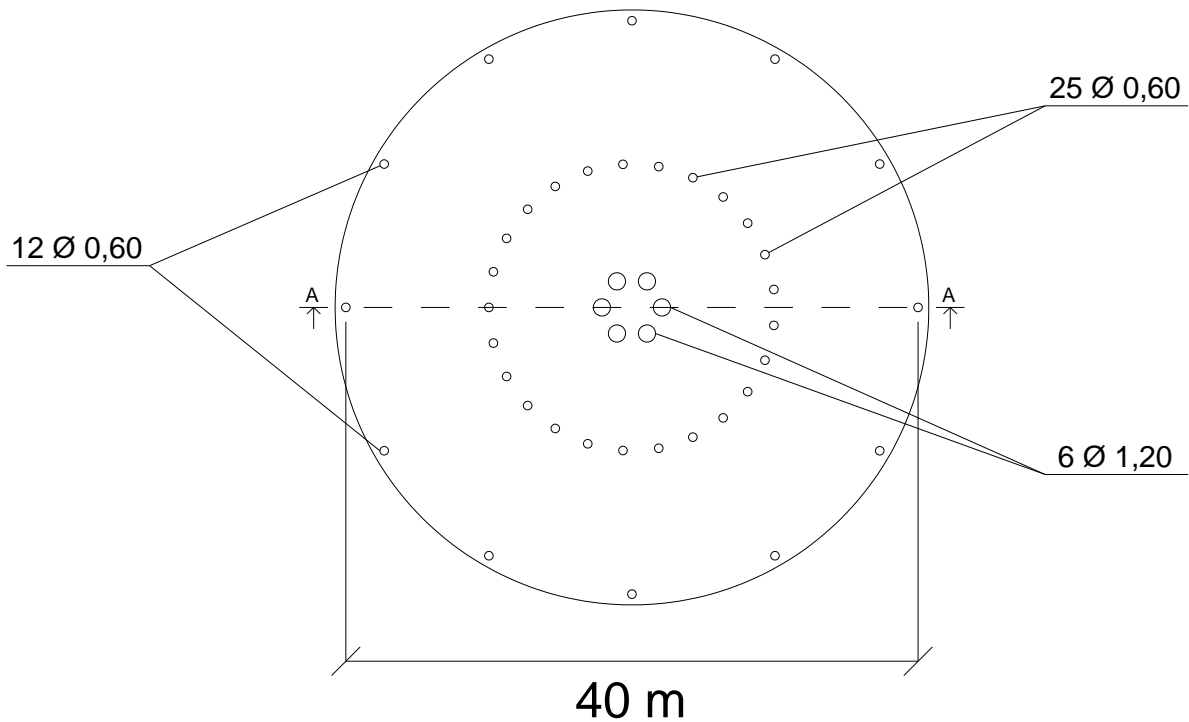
Disposição em planta dos anéis de estacas.
